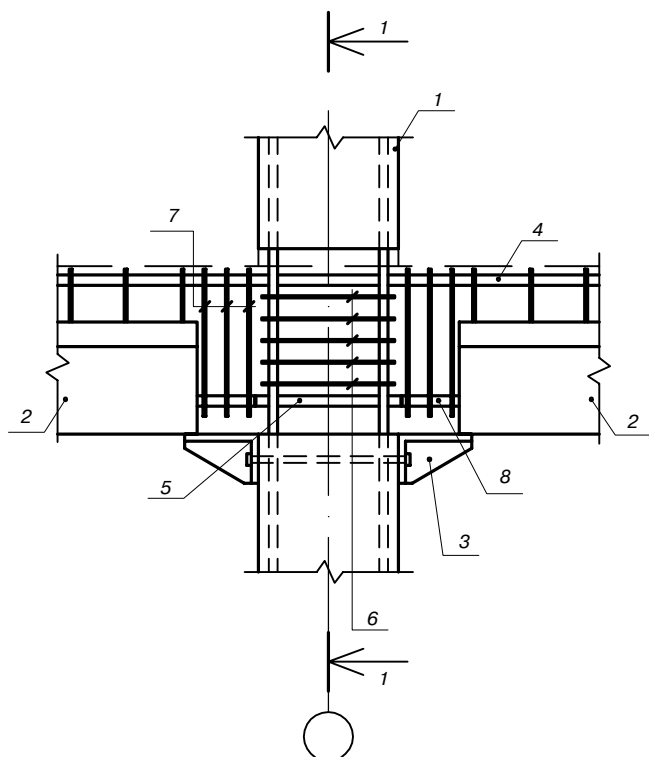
Узел 1. Сопряжение колонна–ригель: 1 – сборная железобетонная колонна; 2 – сборный железобетонный ригель; 3 – монтажный столик; 4 – верхняя арматура жесткого узла; 5 – нижняя арматура жесткого узла; 6 – поперечная арматура колонны; 7 – поперечная арматура ригеля; 8 – выпуски нижней арматуры ригеля
